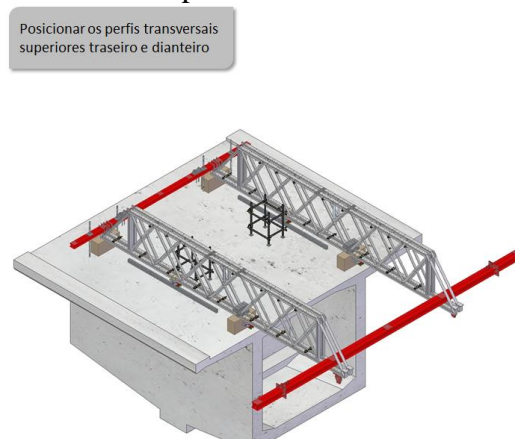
Posicionamento de perfis transversais superiores
